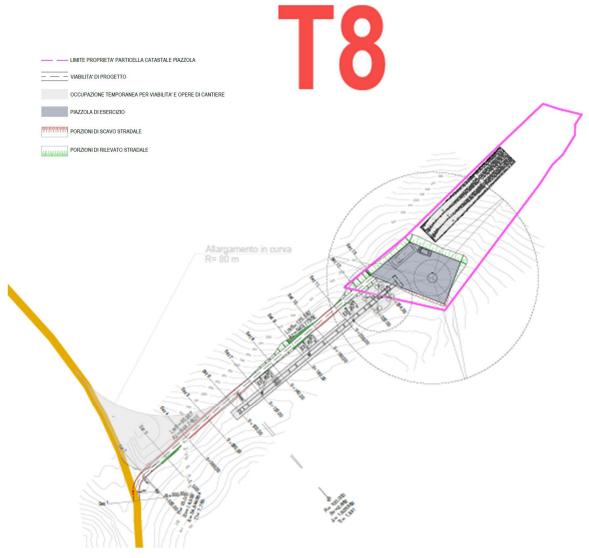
Planimetria del progetto stradale a servizio dell'aerogeneratore T8
